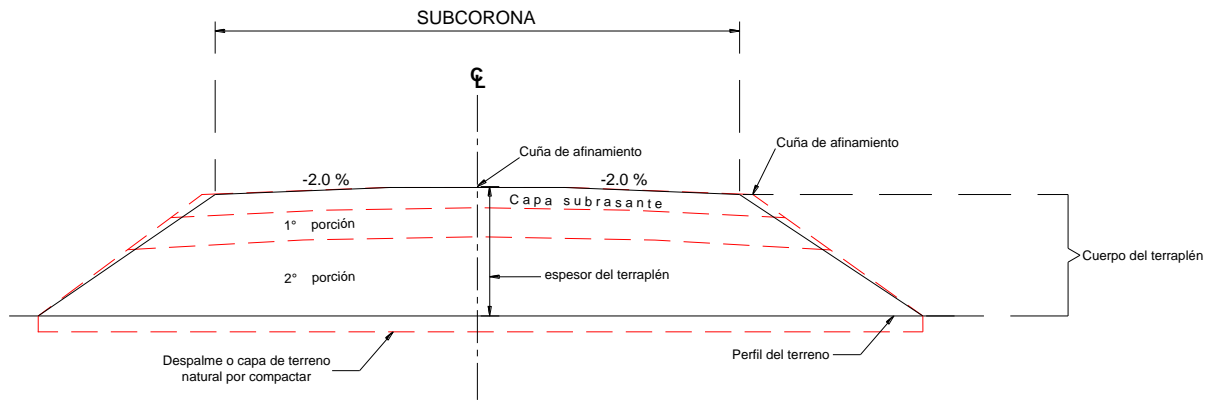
SECCIÓN DE CONSTRUCCIÓN DE UN TERRAPLÉN EN TANGENTE
